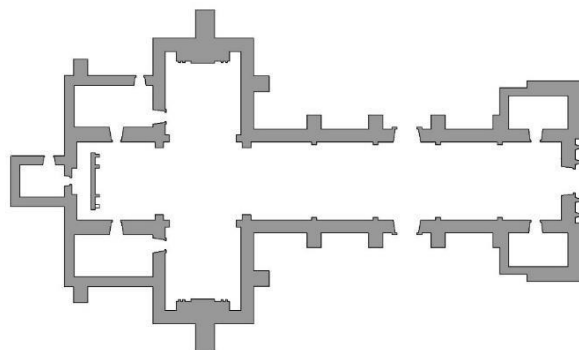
Planta de muros que probablemente sigue la cimentación
